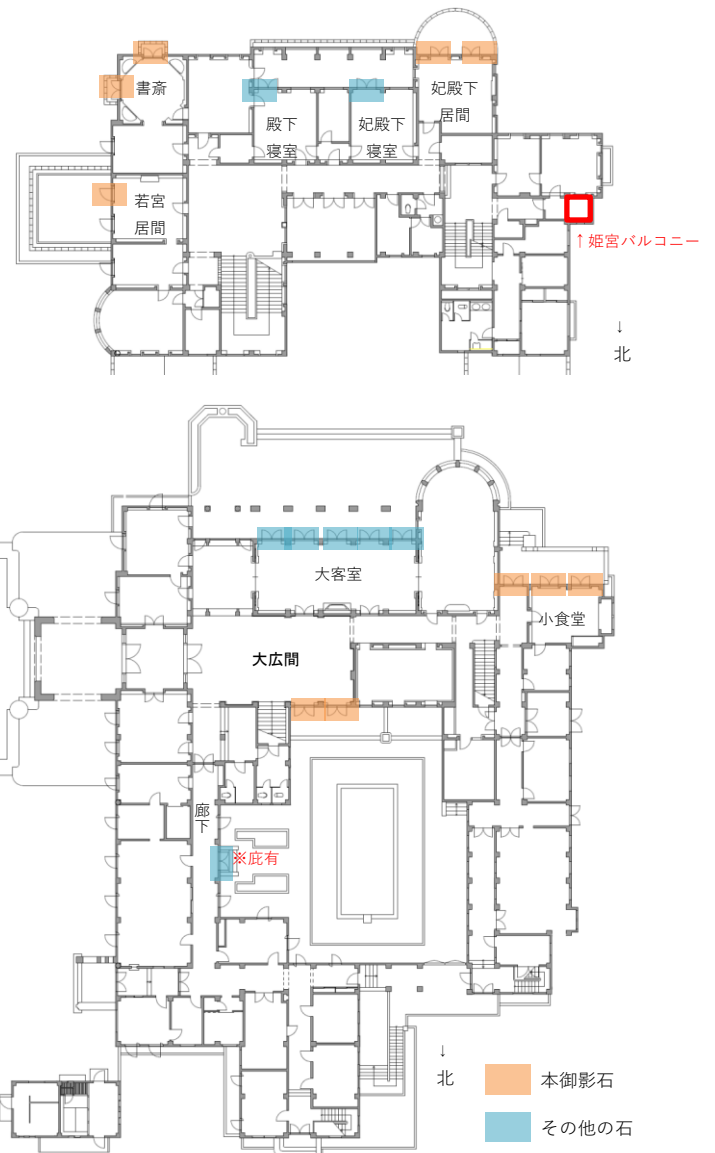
沓摺石調査（上：2階平面図・下：1階平面図）
